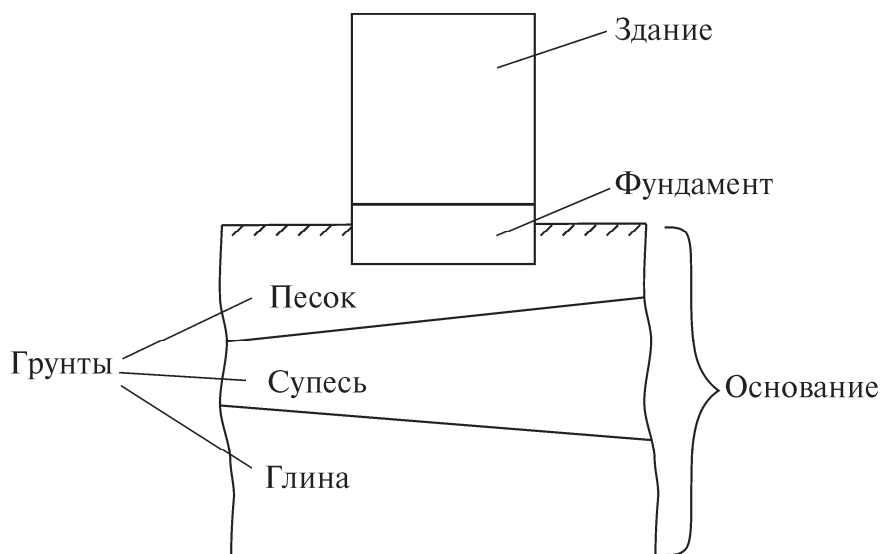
Система здание – фундамент – основание (грунты)
